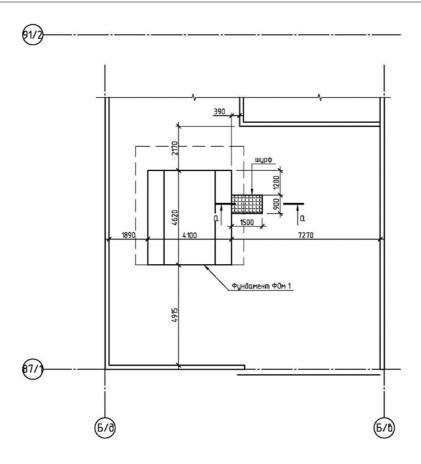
Привязка фундамента ФОм 1 в плане к стенам здания (с расположением шурфа)
